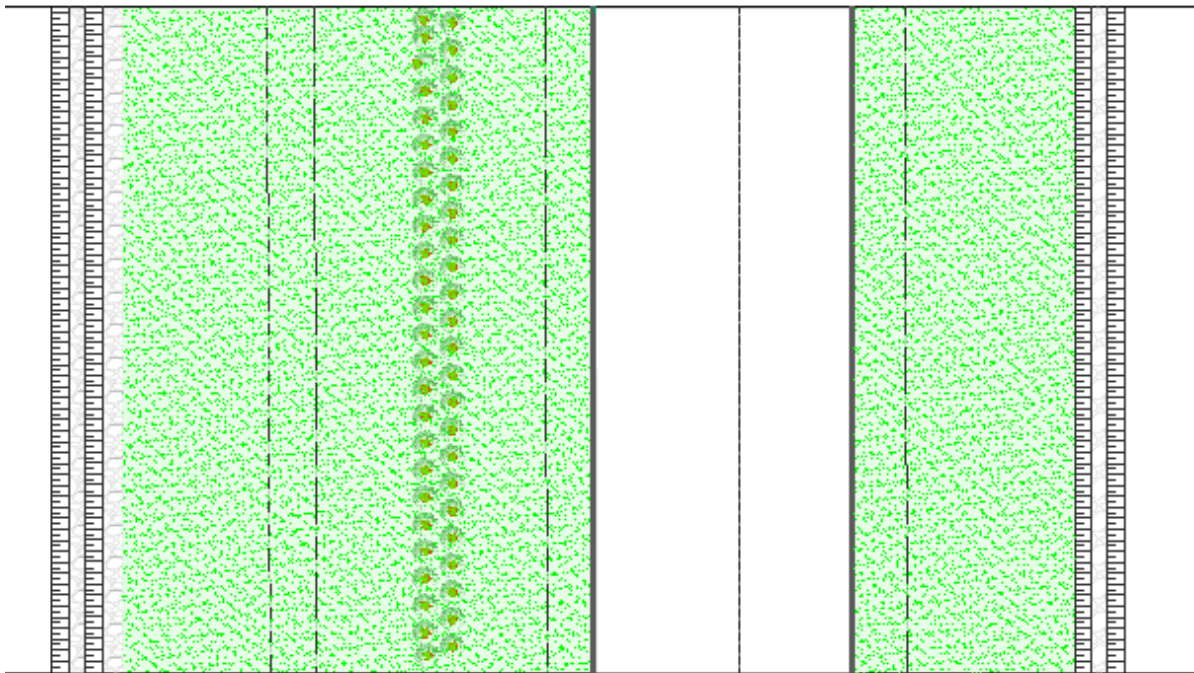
La disposizione planimetrica delle specie arbustive di progetto
